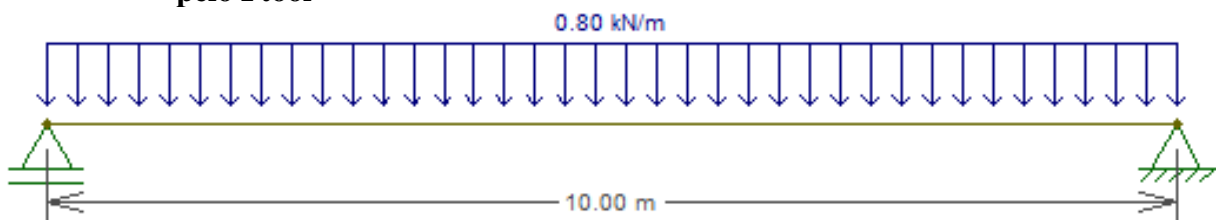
Distribuição de carga da laje em uma viga biapoiada gerada pelo Ftool
